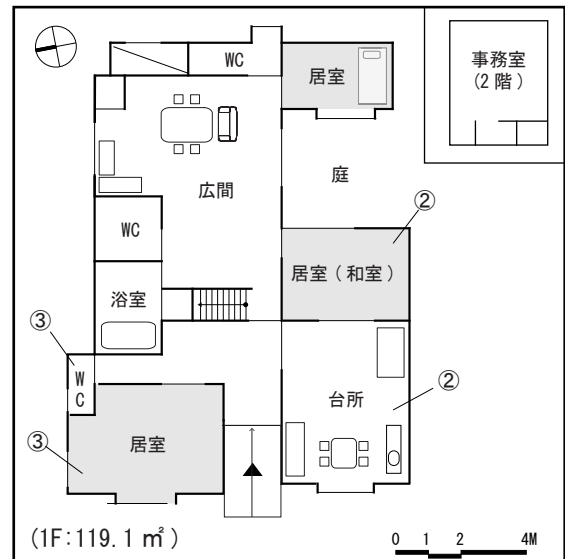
Y1 平面図 (②, ③) [1996.2]
